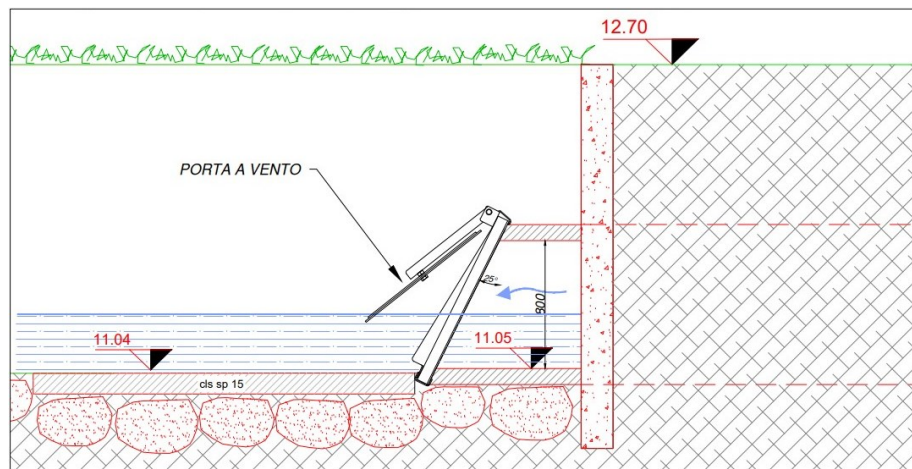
Sezione del collegamento con il fosso Duca degli Abruzzi
